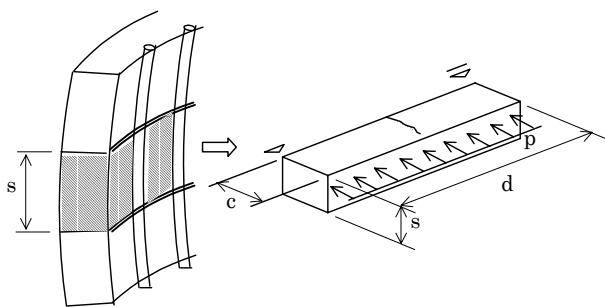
軸方向鉄筋のはらみ出しによる力とかぶりコンクリートのモデル化
